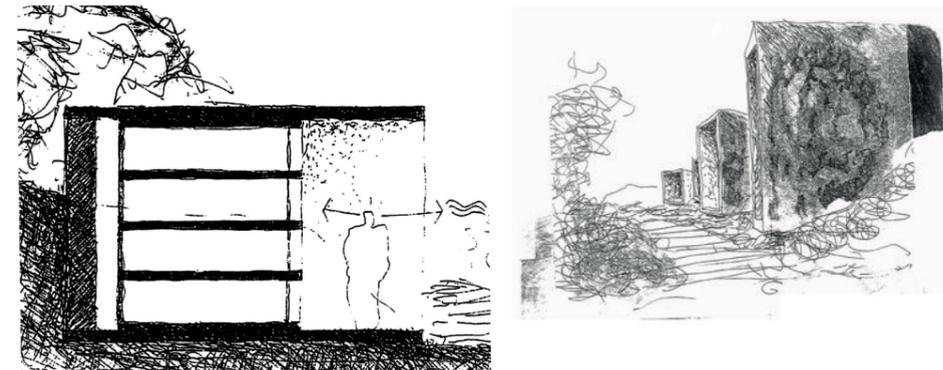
\_C3: fachada de mausoleos, Fisterra
